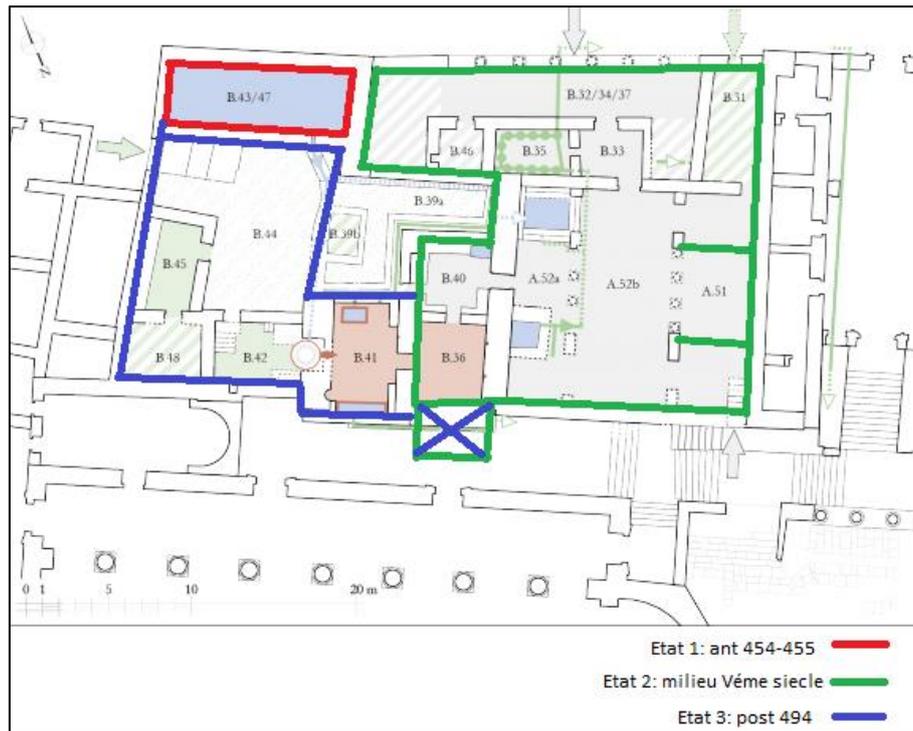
Plan des bains de Gerasa. Source LEPAON traité par l'auteur ²²⁸
